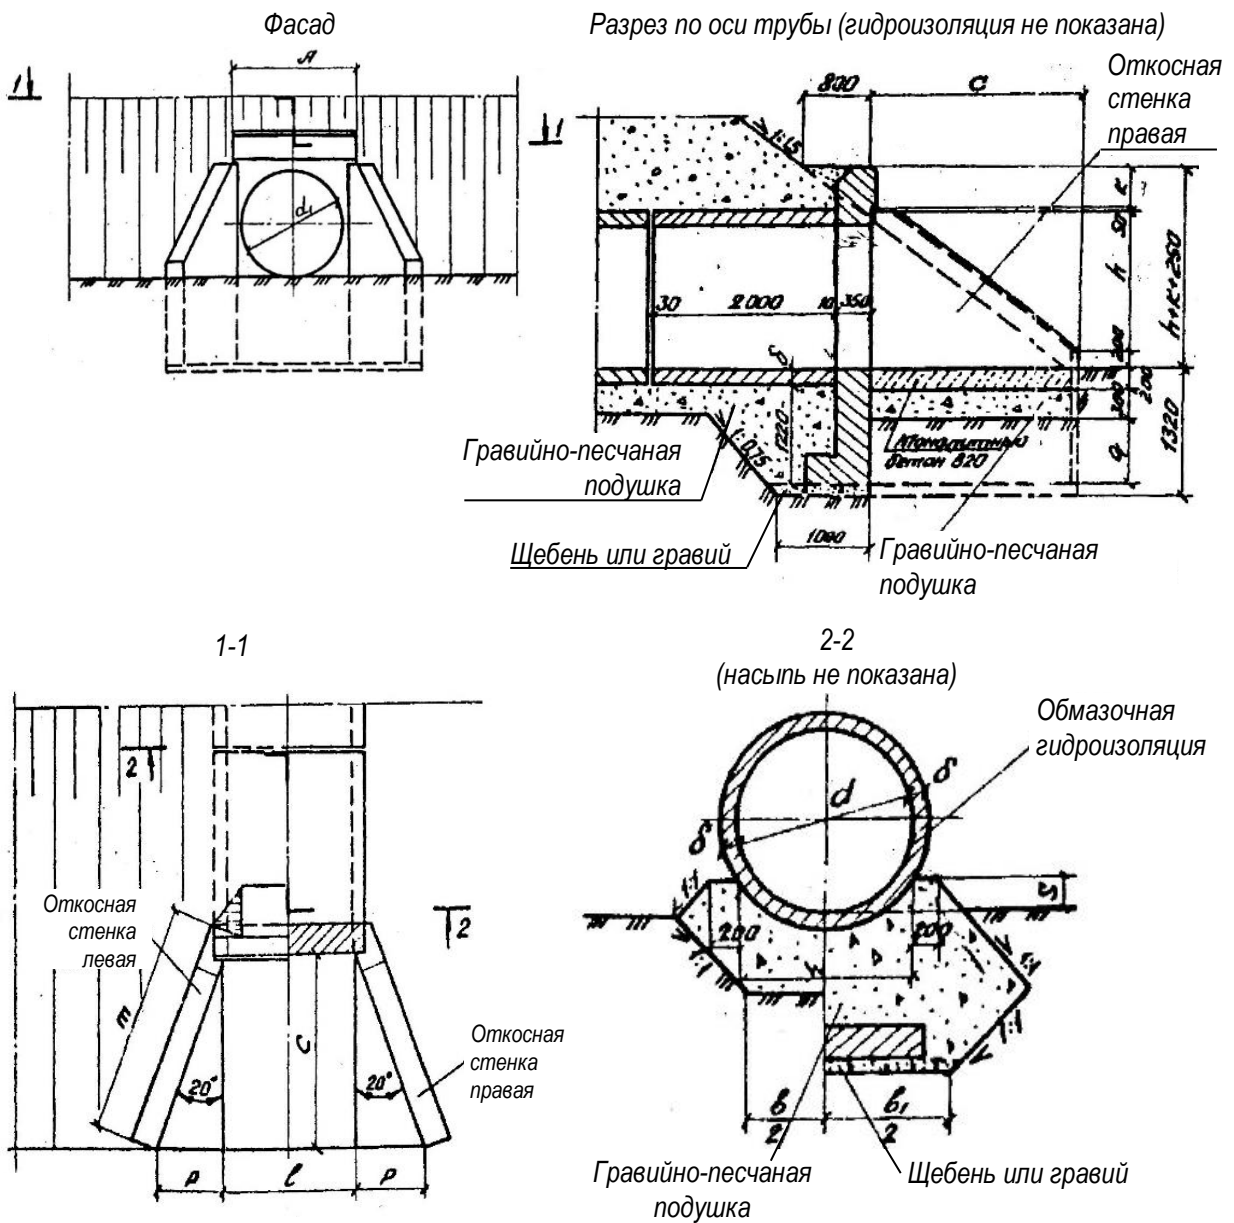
Конструкция раструбного оголовка трубы с цилиндрическим звеном
